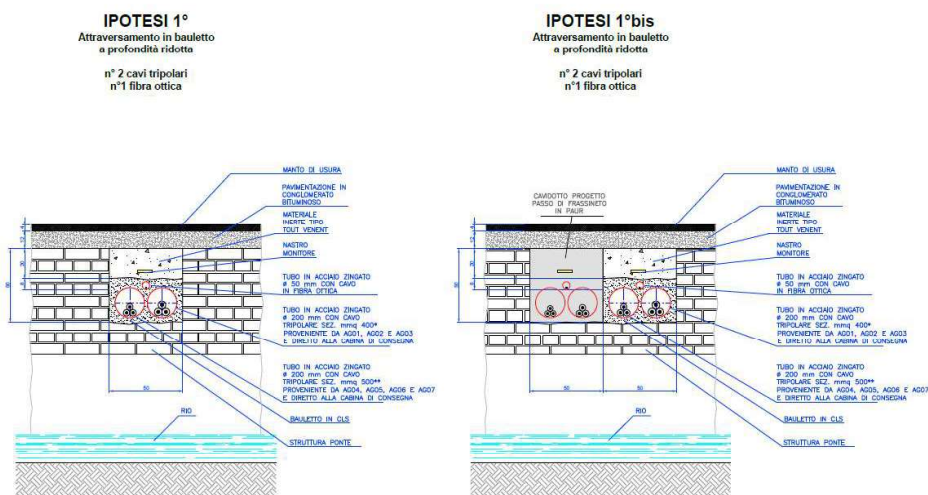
Sezione tipologica di attraversamento a profondità ridotta
